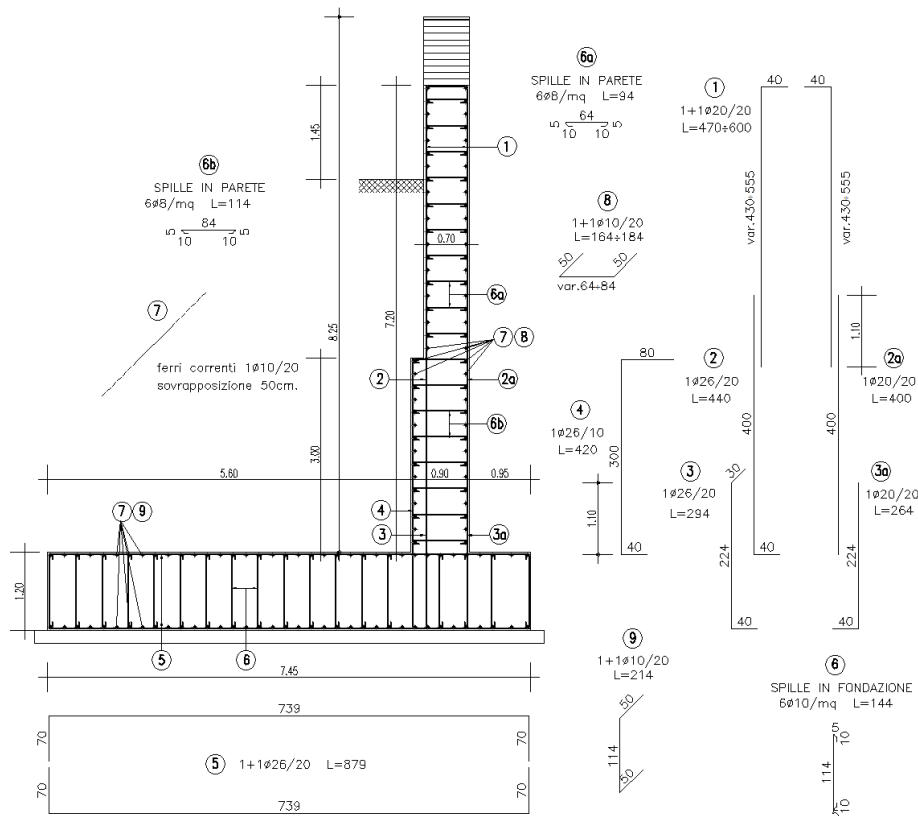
Stato di fatto - Sezione tipo conci 1-5 - Carpenteria e armatura
